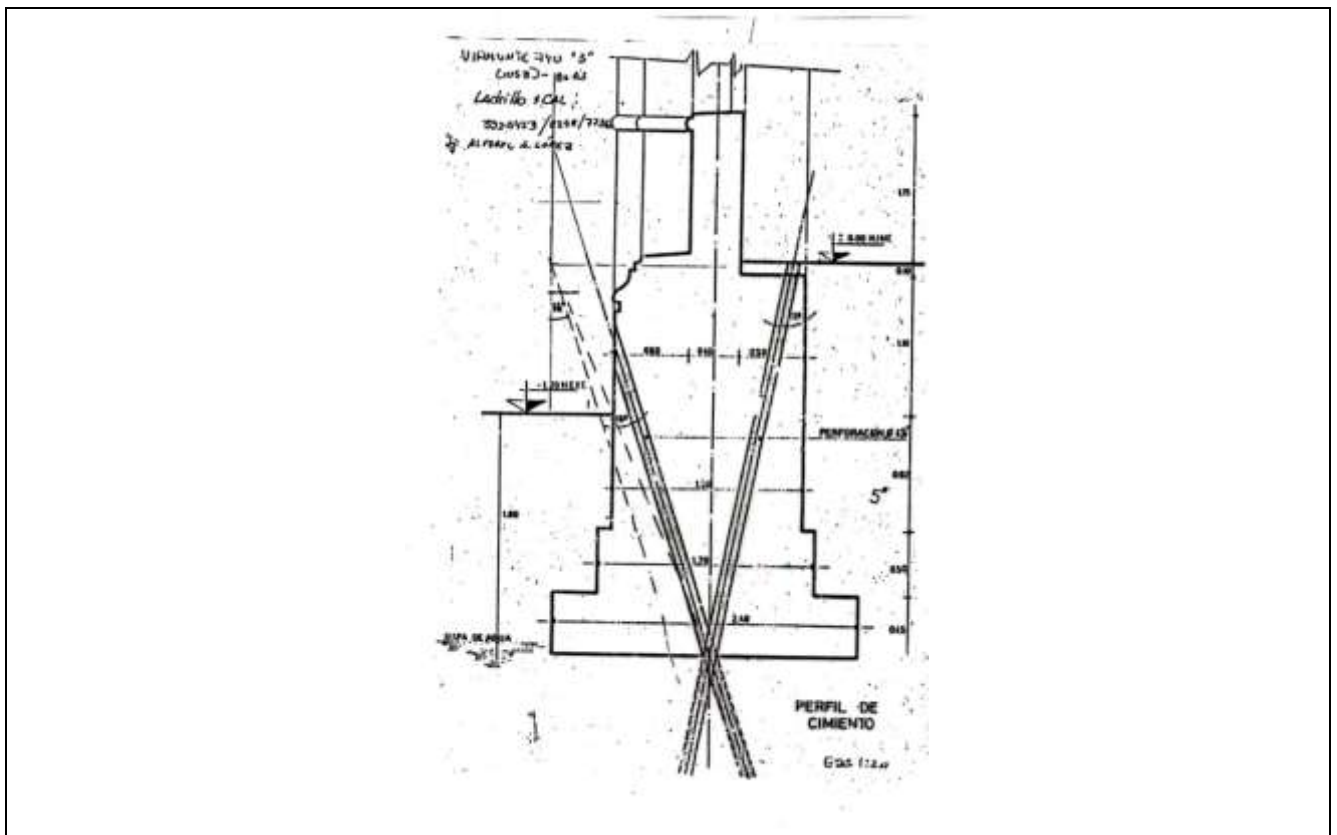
Esquema de recalce de un muro fundado por empataamiento. La transferencia de cargas se da por fricción entre pilote y mampostería. Los elementos están colocados de a pares en forma de “pata de catre”.
